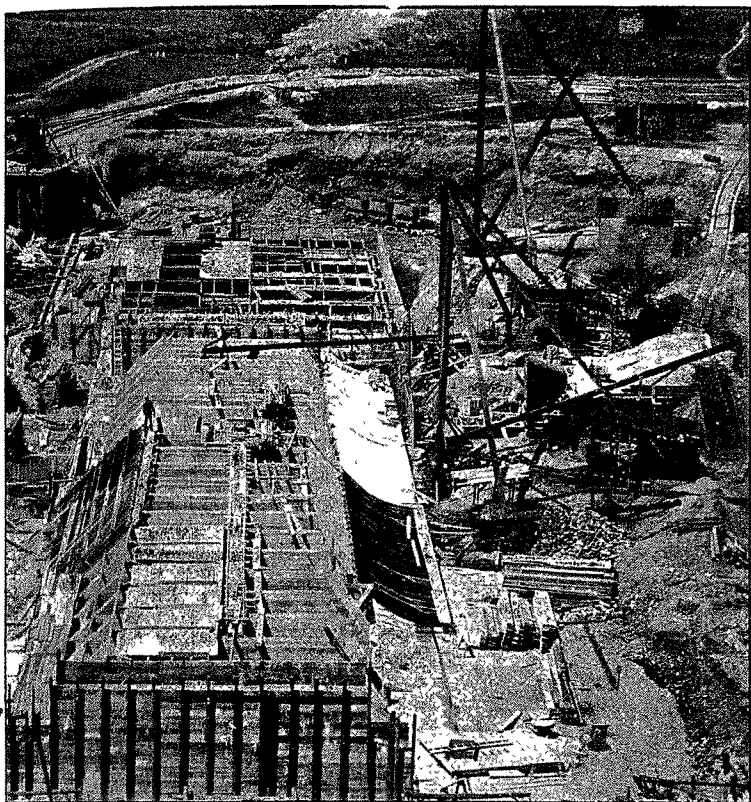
Vue du barrage et des fondations de l'usine génératrice pendant la construction.
